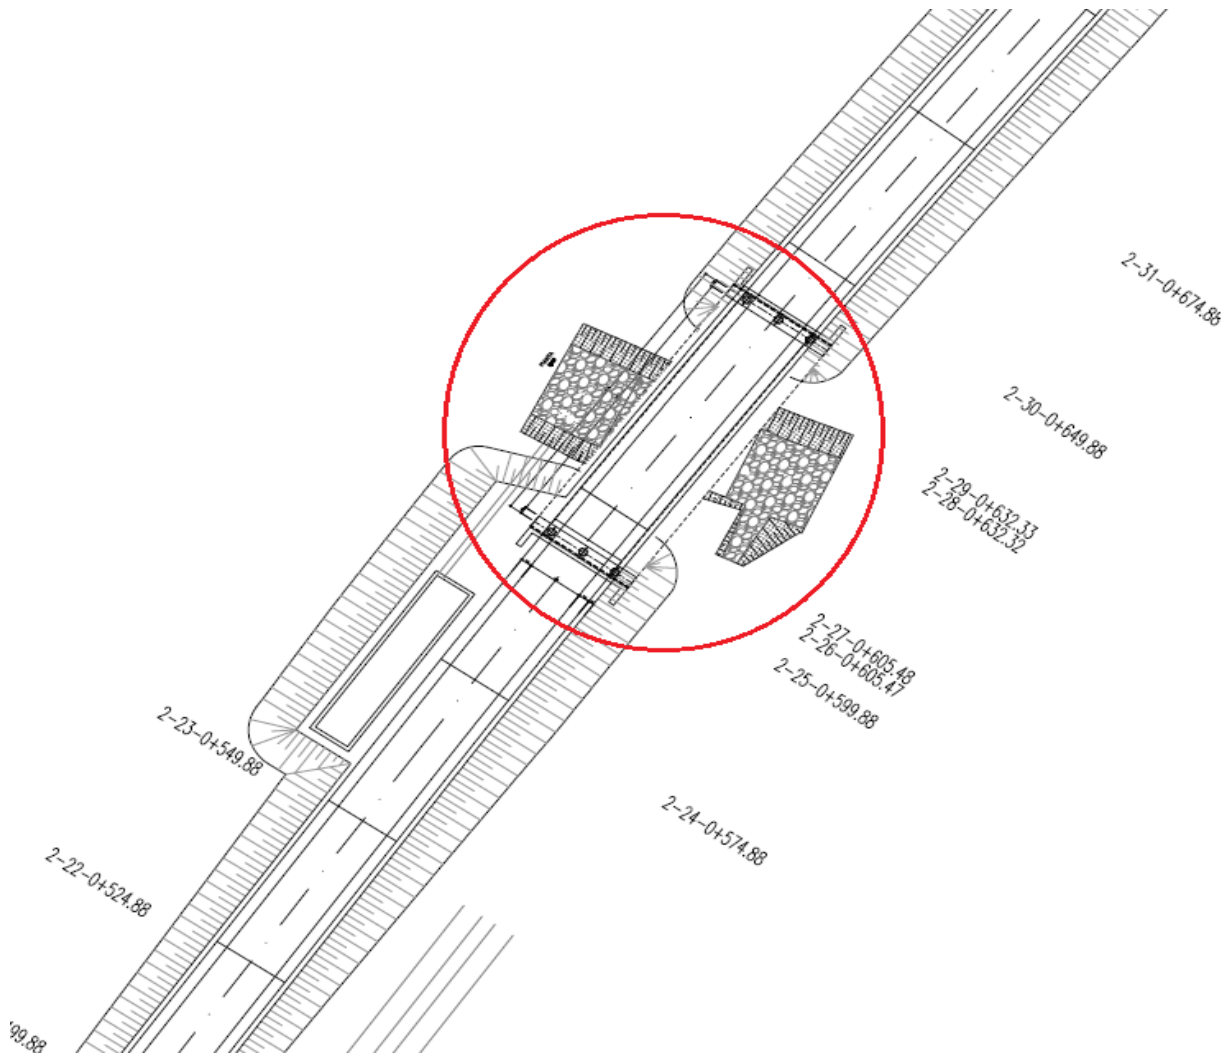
INDIVIDUAZIONE DELL'IMPALCATO ALL'INTERNO DELLA PLANIMETRIA GENERALE
